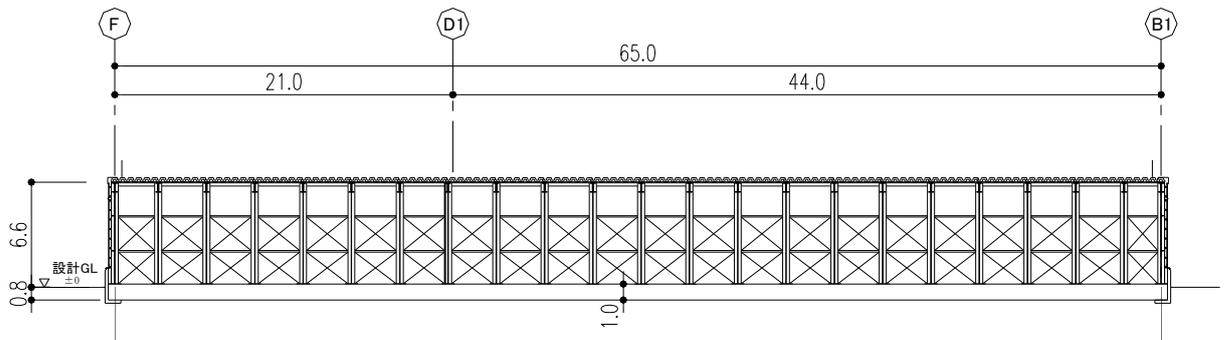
設備棟 B-B断面図 (EW方向) (単位:m)
